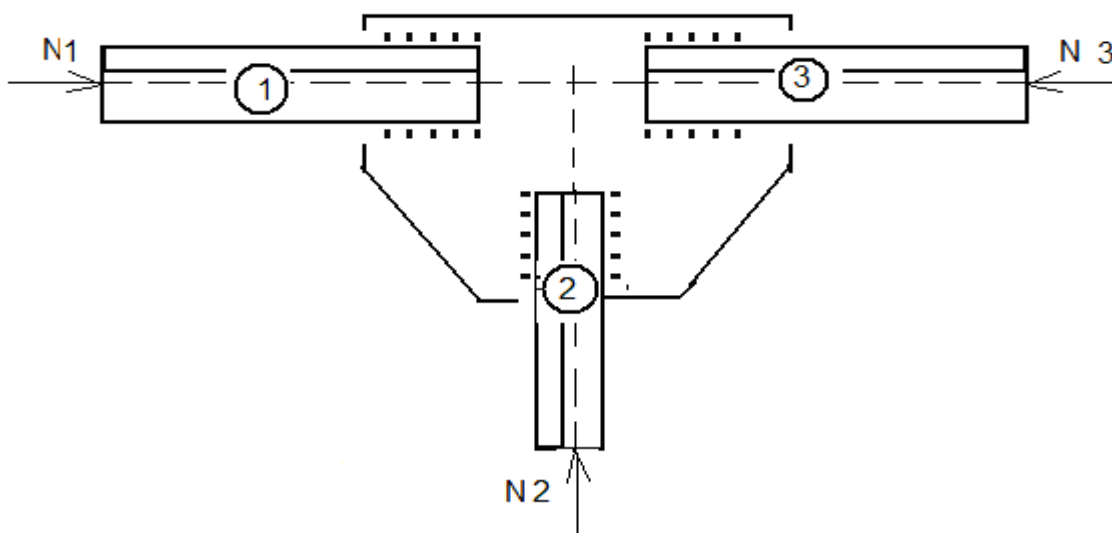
Металева стропильна ферма. Вузол № 1
